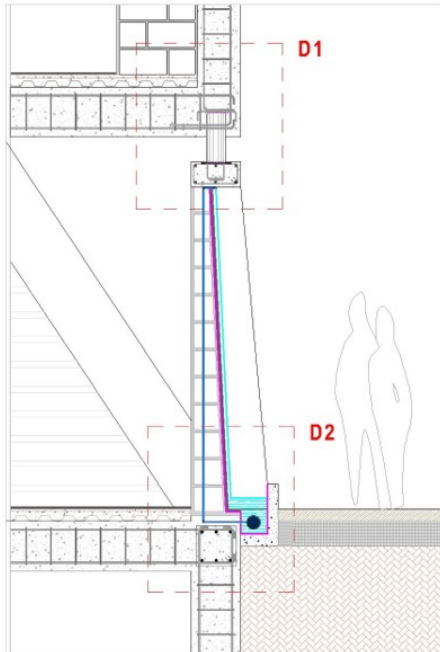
Planos, Plantas, Fuente: Fabrizio Benenaula.
